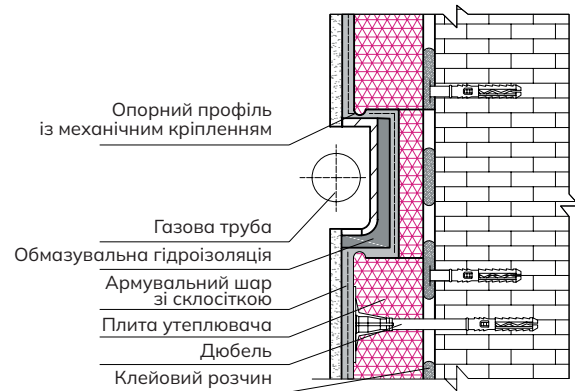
Утеплення стіни з газовою трубою на фасаді
